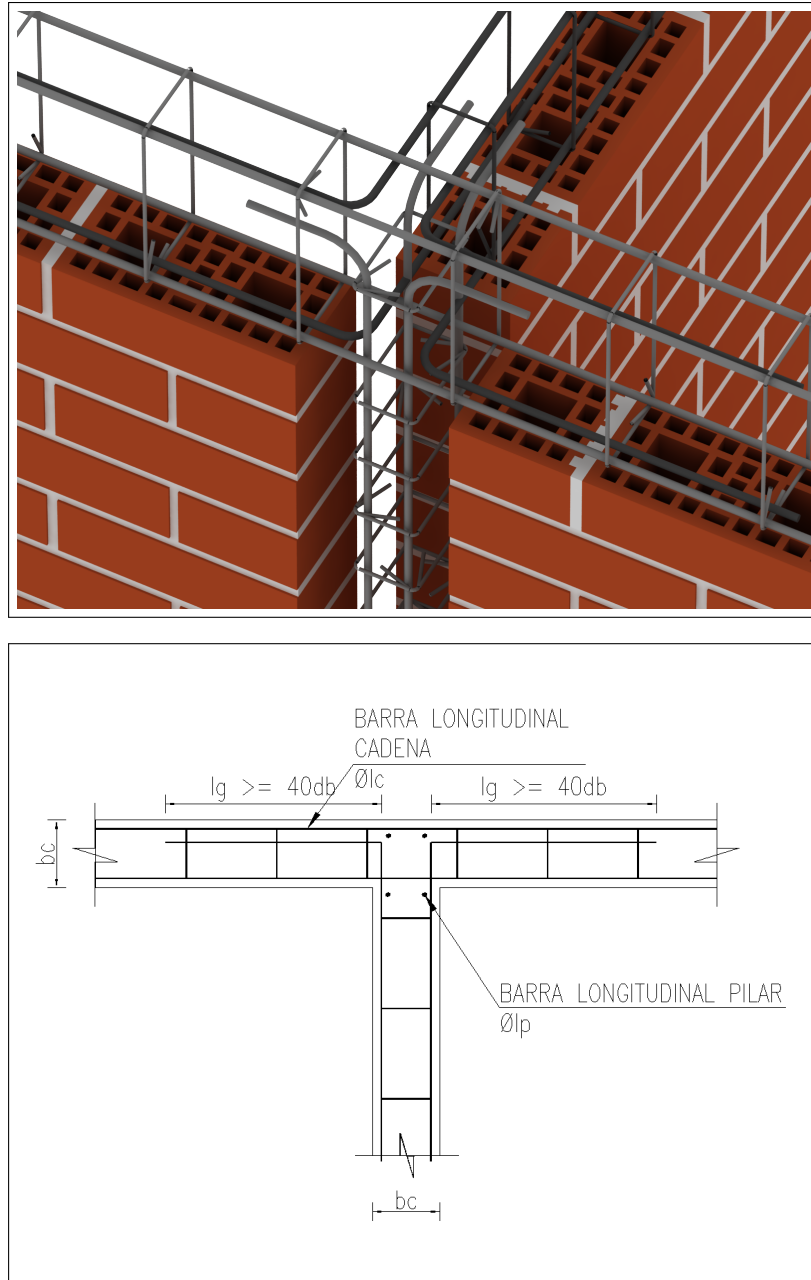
Detalle de barras longitudinales de cadenas de confinamiento en encuentro de muros en T. Caso B
